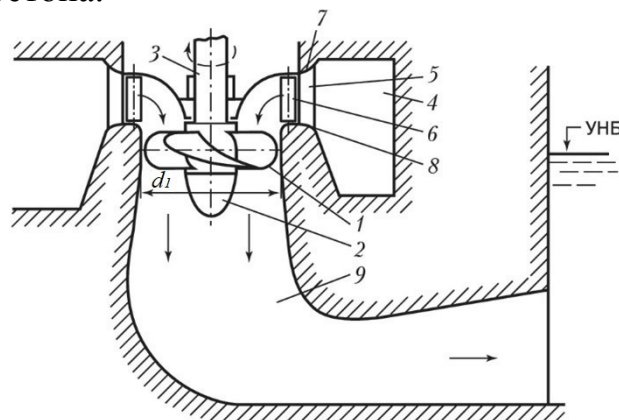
Схема осевой турбины: 1 - лопатки рабочего колеса; 2 – втулка с обтеканием; 3 – вал; 4 – камера турбины; 5 – статор; 6 – сопловой аппарат с лопатками; 7,8 – спорное пояса статора; 9 – отсасывающая труба; УНБ – уровень нижнего барельефа; d_1 – диаметр внешнего колеса.
